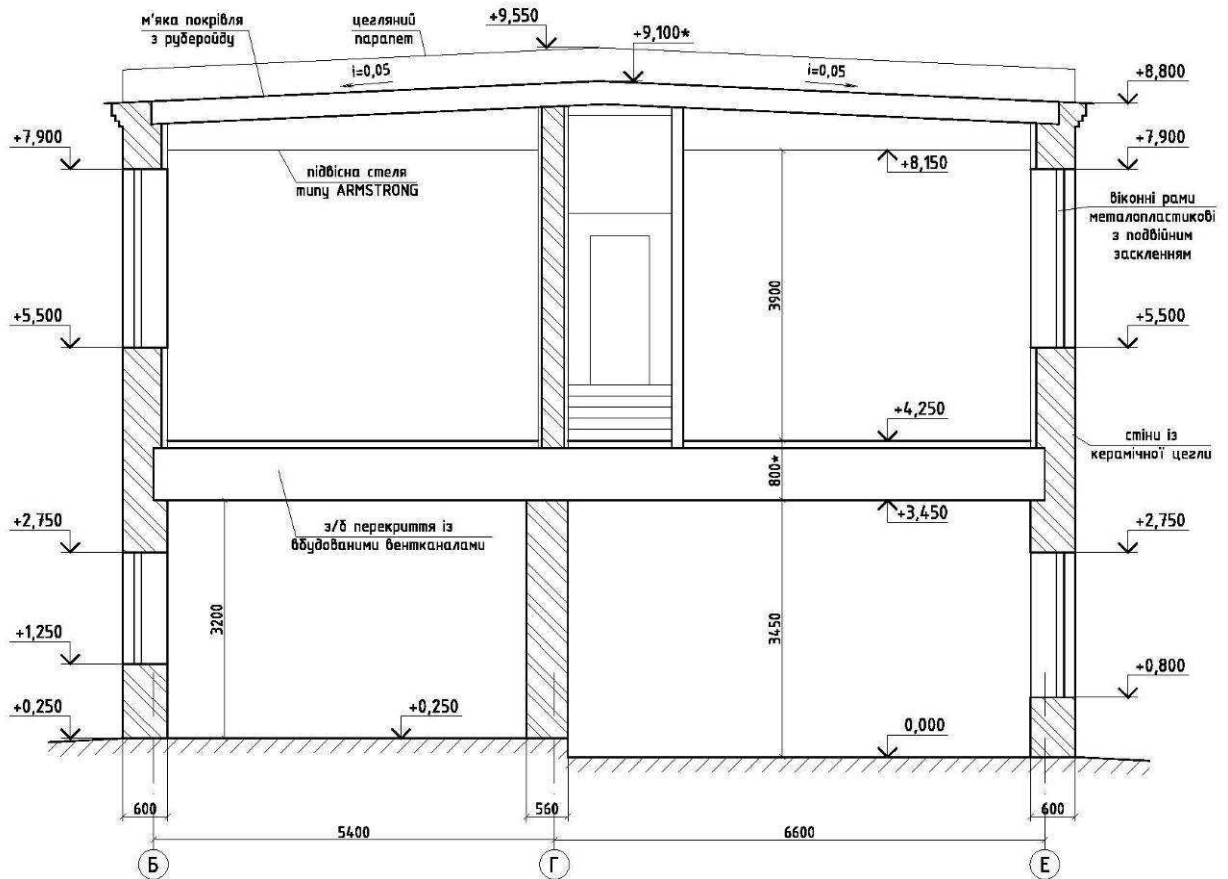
Поперечний розріз 3-3 між осями 8-9 будівлі цеху фасування, складу тари
